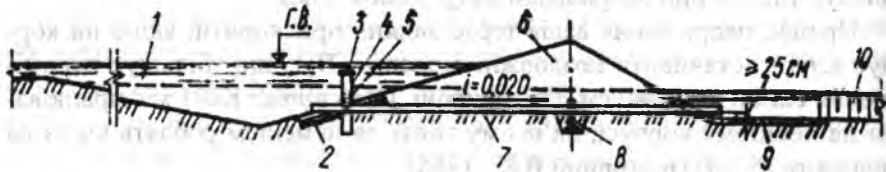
Трубчастий водовипуск водозатримуючого валу: 1 – ставочок; 2 – залізобетонна плита; 3 – кришка або чіп; 4 – стояк водовипуску; 5 – отвори у нижній частині стояка; 6 – тіло валу; 7 – трубопровід (лежак); 8 – діафрагма; 9 – кріплення із залізобетонних плит; 10 – канава
